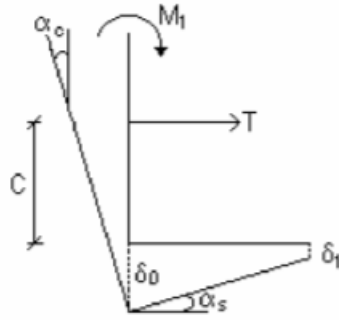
Modelo de giro y del asentamiento en zapata medianera con viga aérea.
